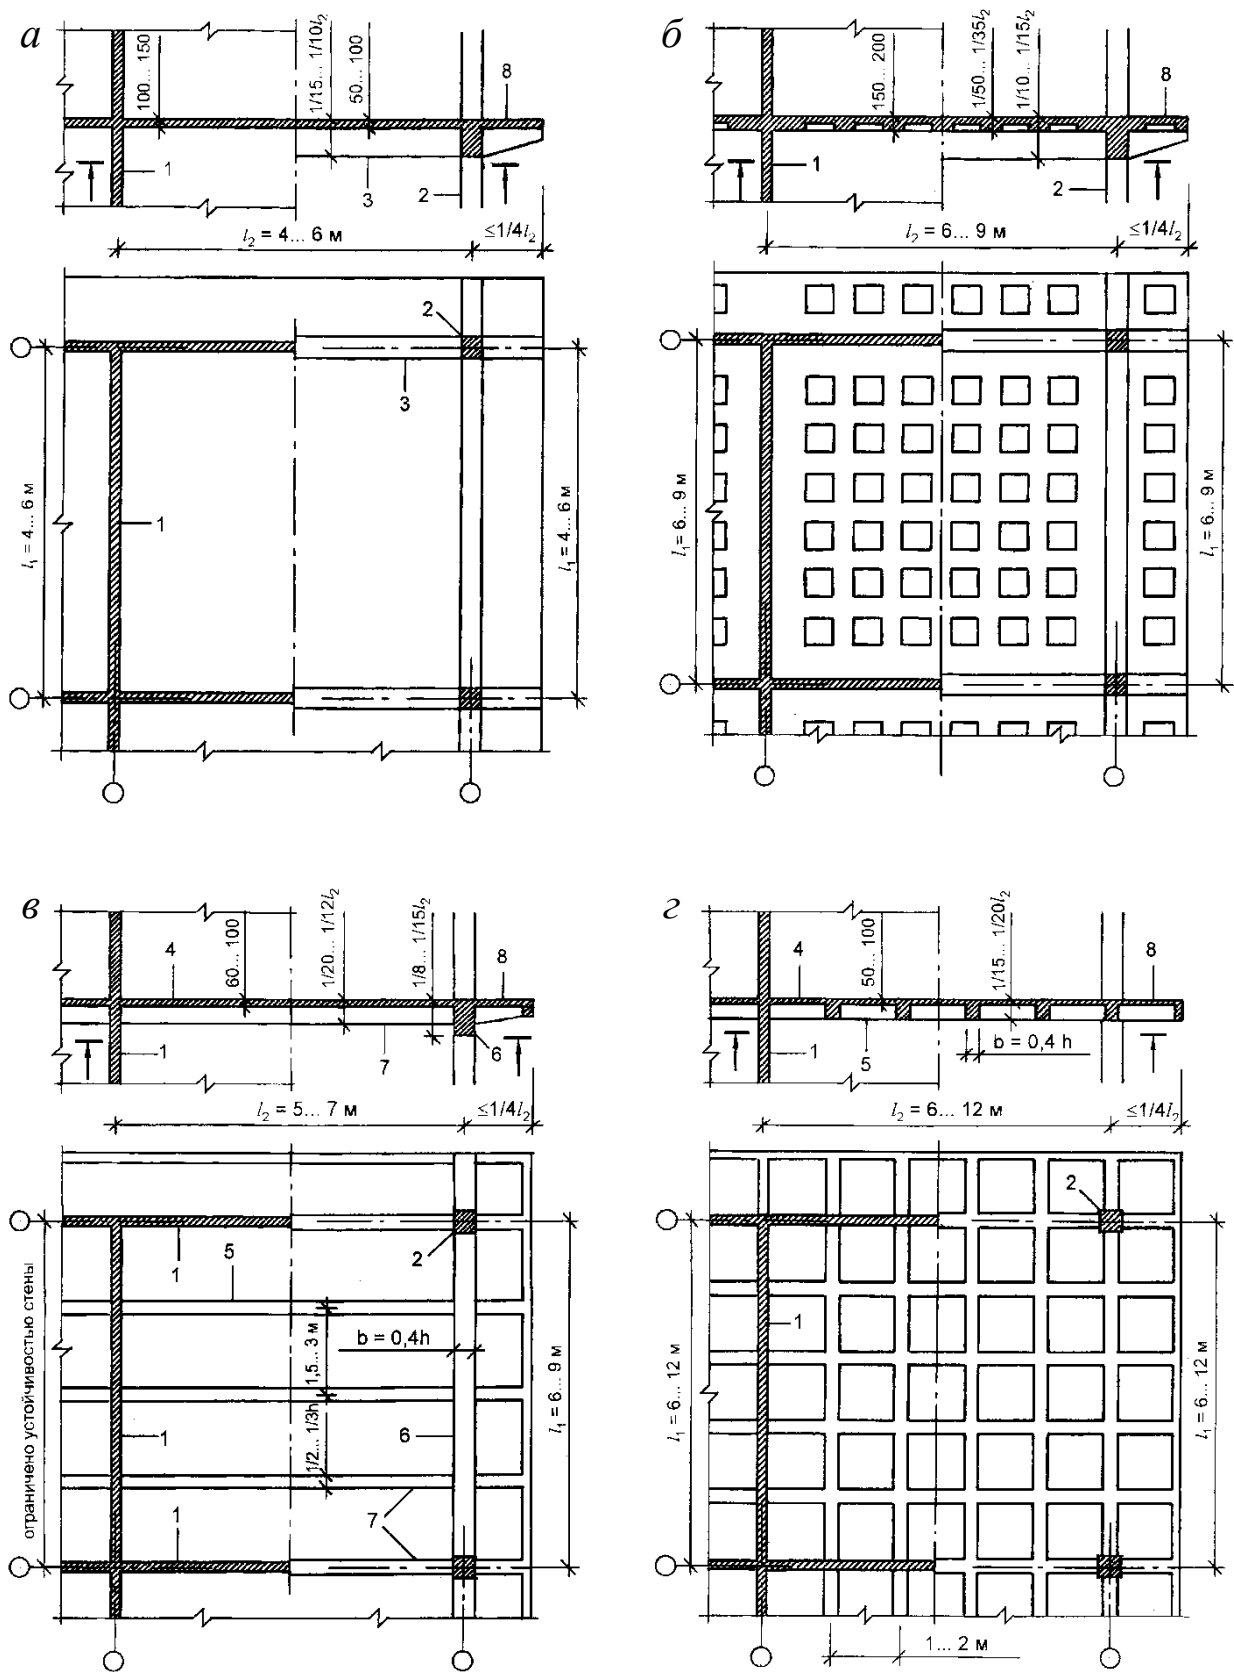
Виды монолитных перекрытий в зданиях стеновой и каркасной конструктивных систем:
